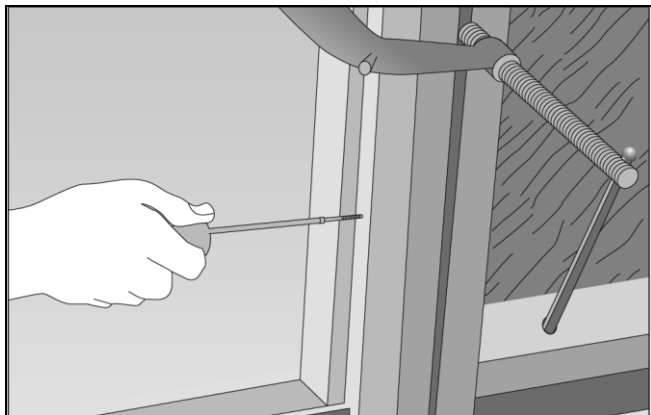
Крепление дверной коробки к стойкам с помощью винтов (Andersen)
